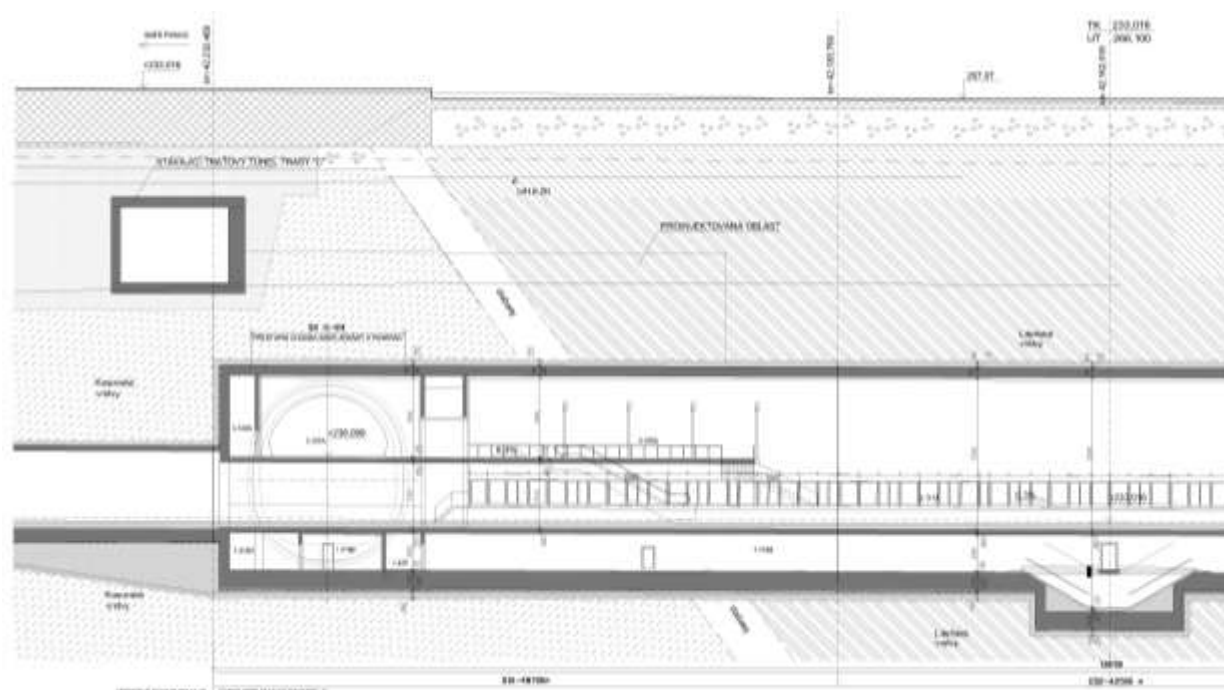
Půdorys – Úroveň nástupiště
